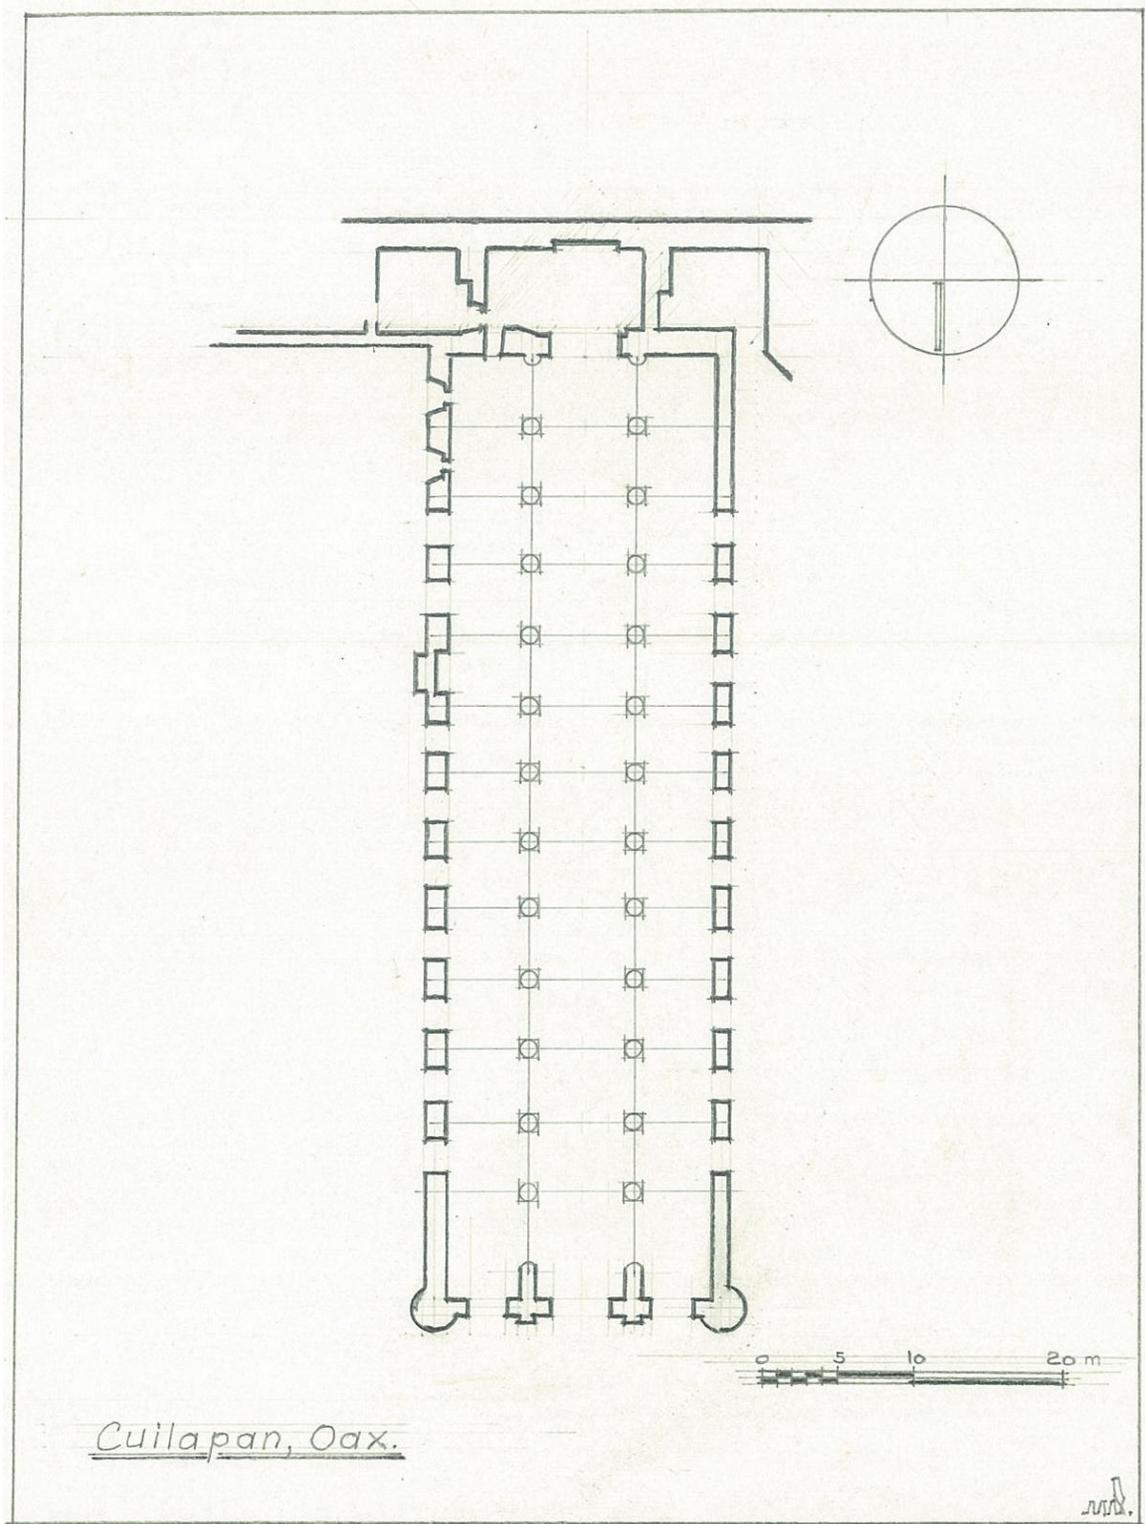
Cuilapan, Oax. Planta de la basílica (Dibujo del autor)
